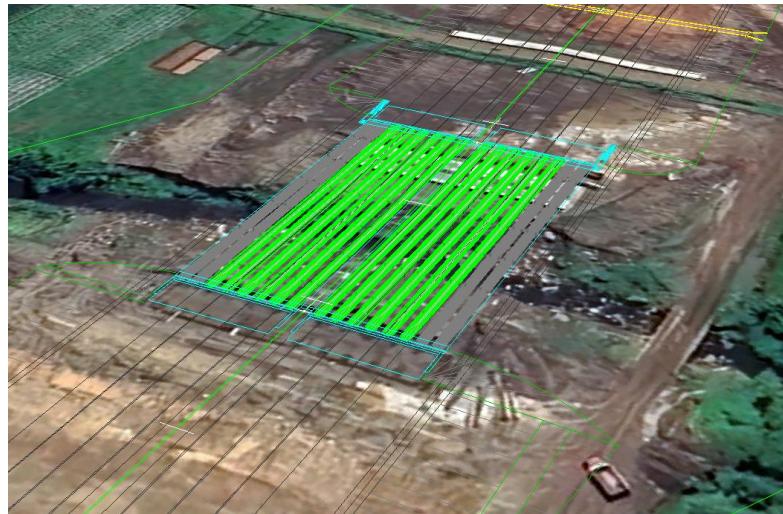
1 Lokasi Erection PC-I Girder Jembatan Lusah STA 29+568
